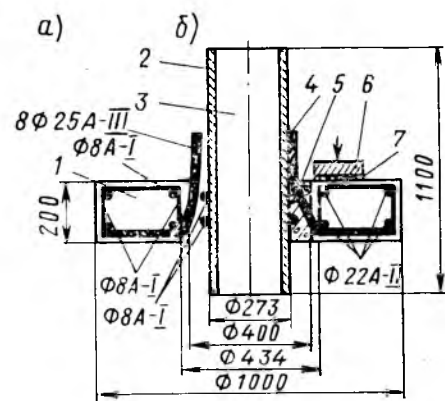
Фрагмент узла сопряжения колонны с перекрытием: положение стыковочных арматурных выпусков при подъеме плиты на проектную отметку (а); плита на проектной отметке, выпуски приварены к колонне, стык замоноличен (б)
